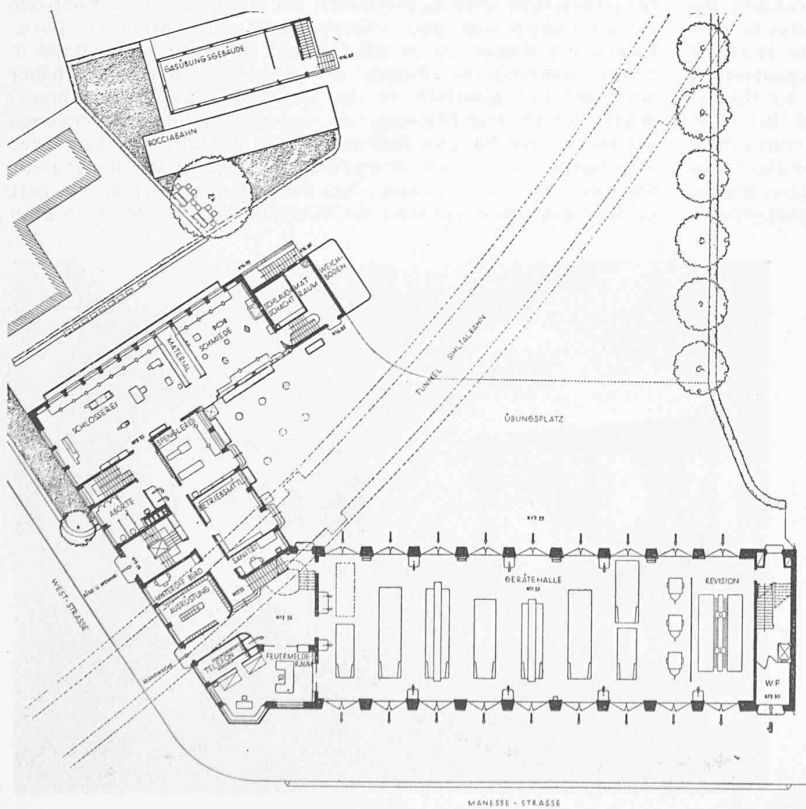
Grundriss vom Erdgeschoss. Ausfahrt Seite Manessestrasse
